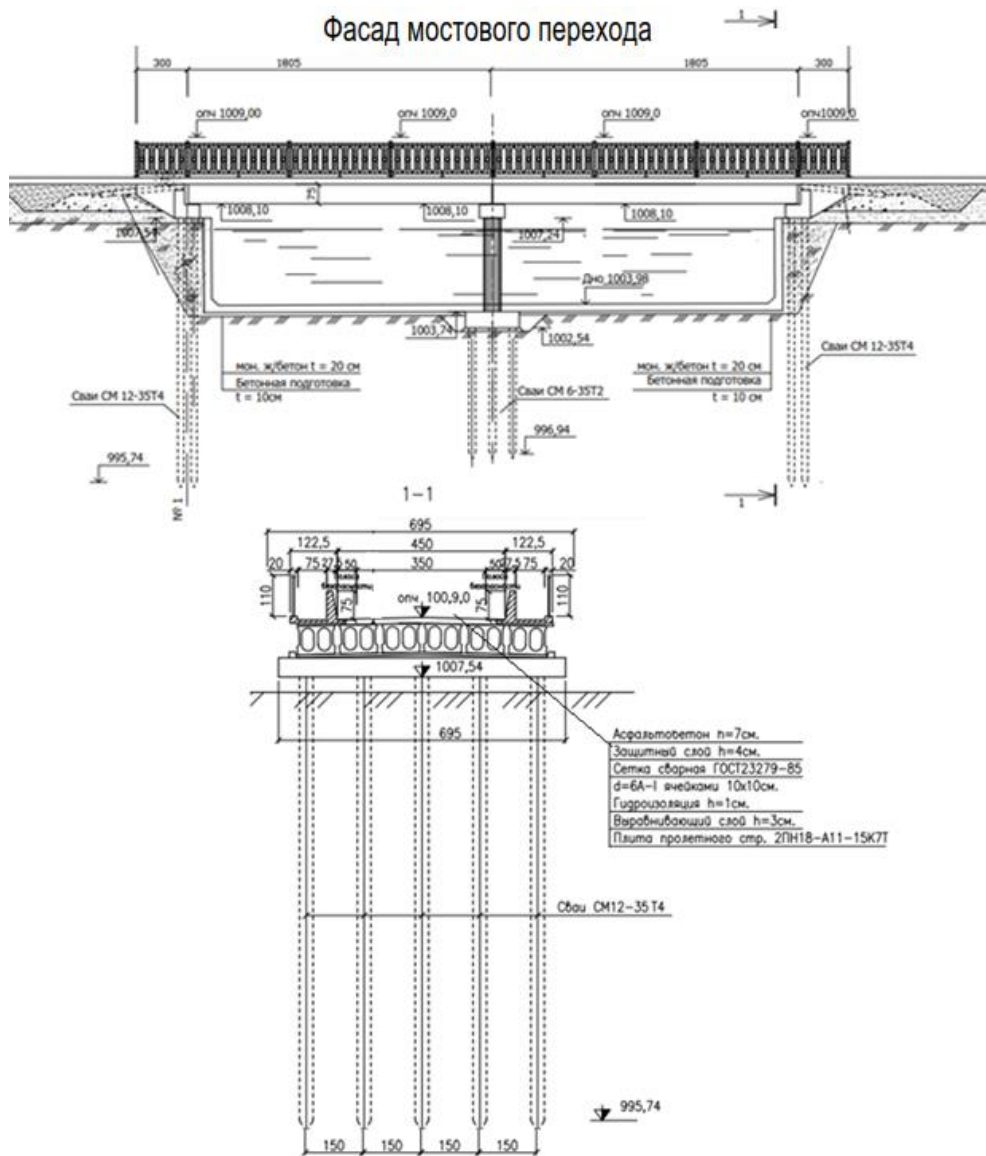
Конструкция мостового перехода со свайным фундаментом
